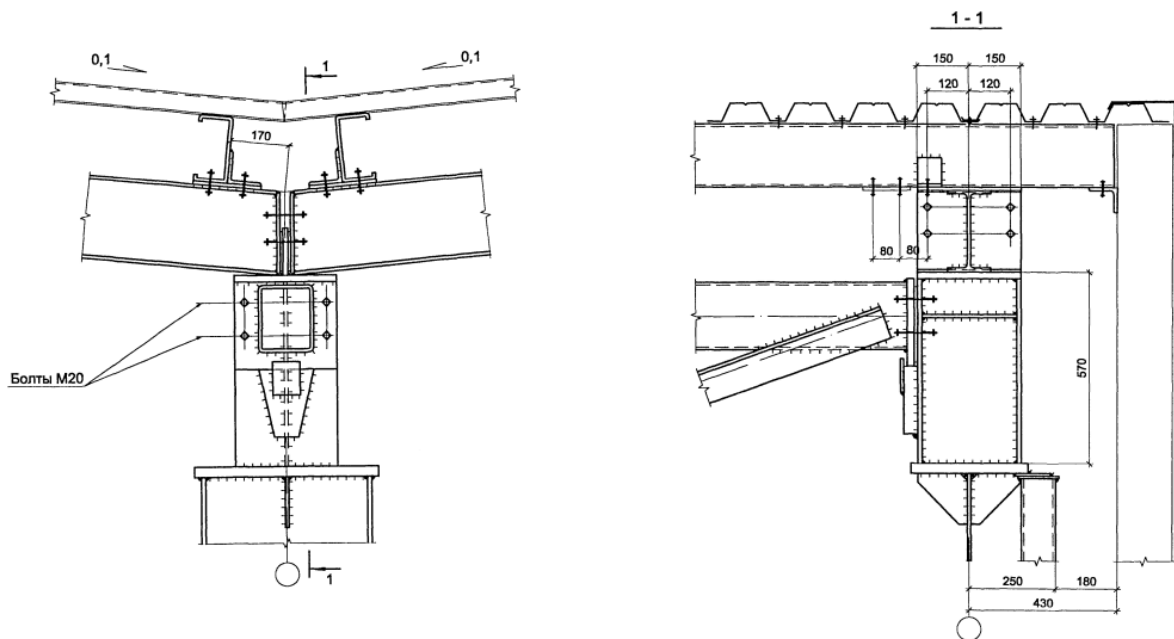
Принципиальное решение узла опирания подстропильной фермы на колонну каркаса
